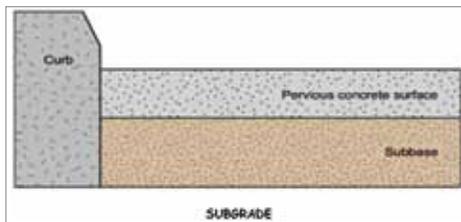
Tipica sezione di pavimentazione in calcestruzzo drenante
